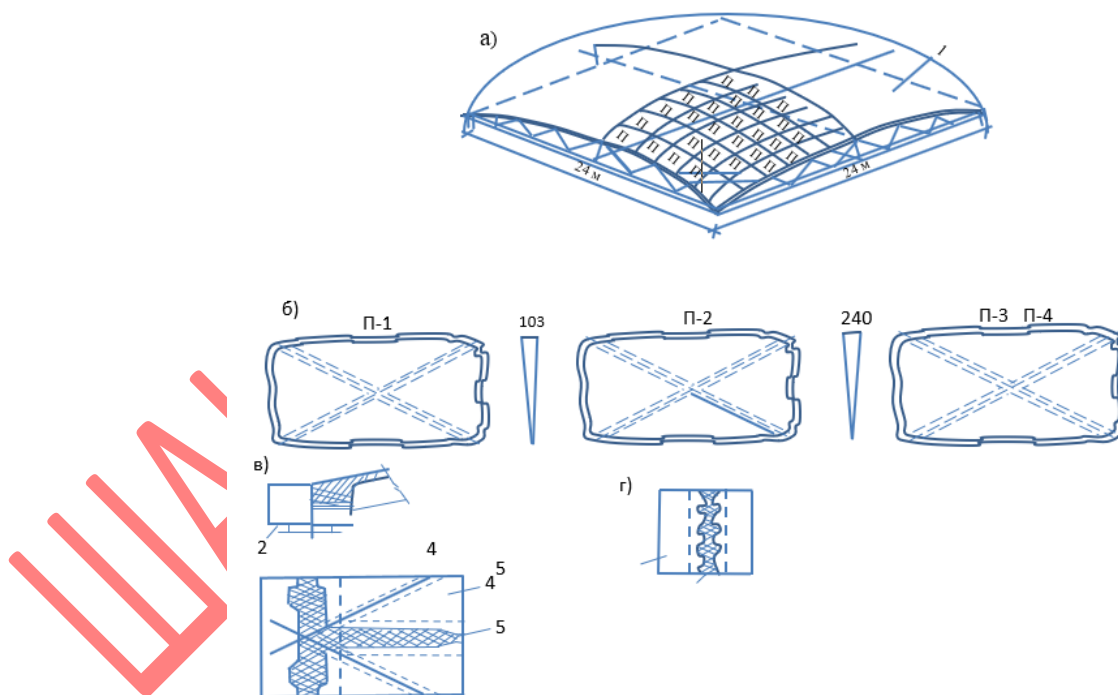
Конструктивная схема сборной пологой оболочки
